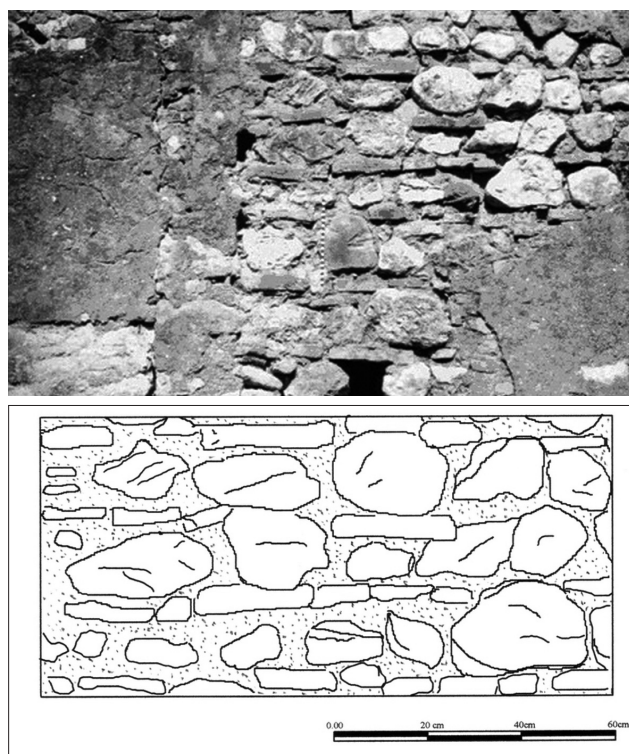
Particolare del paramento Tipo I: foto e rilievo.
